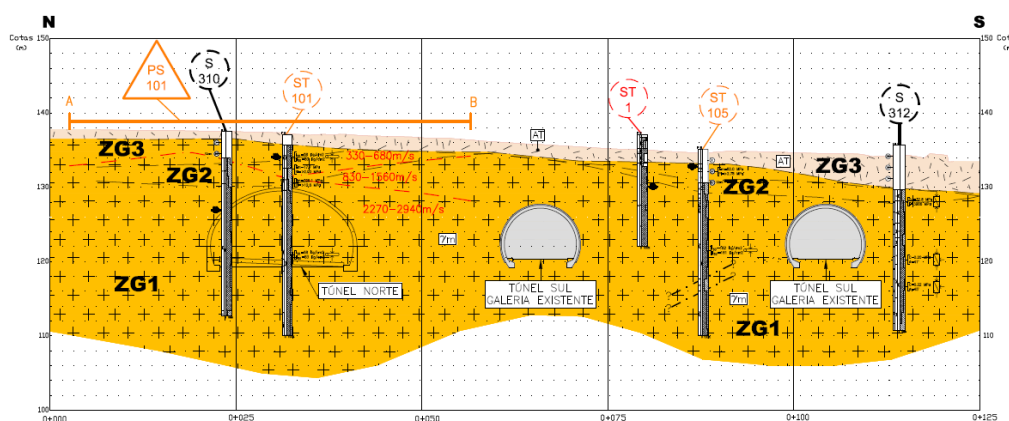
Perfil geológico transversal – Emboquilhamento Poente
